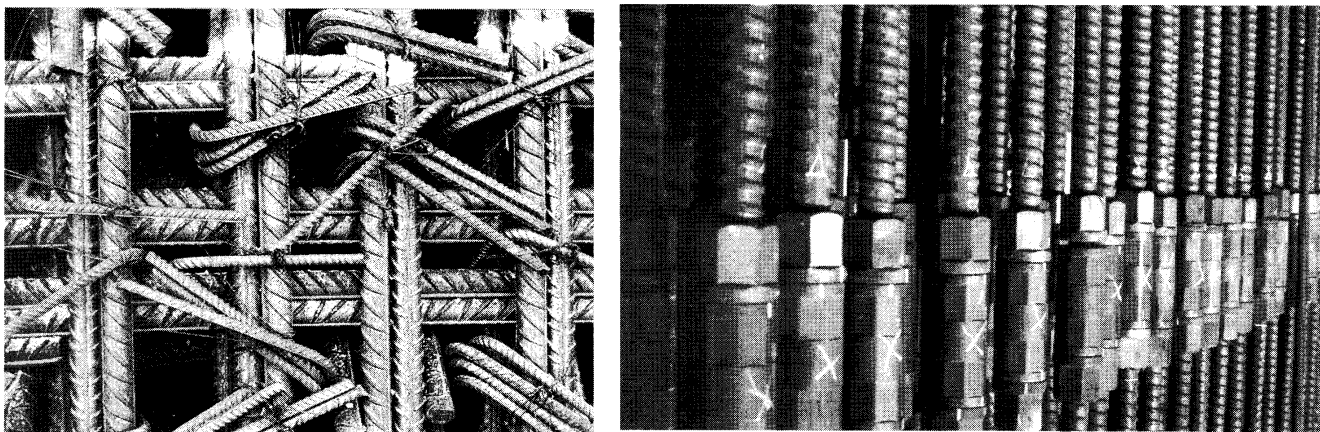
Zonas con grandes concentraciones de armaduras.
